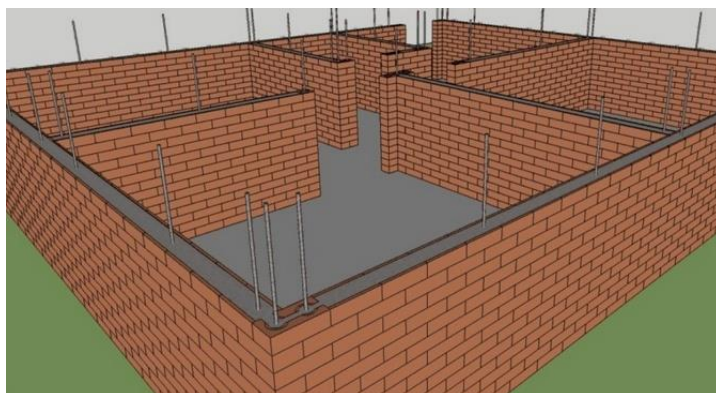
Ejemplo viguetas a 0,90m, sistema constructivo Siconte
